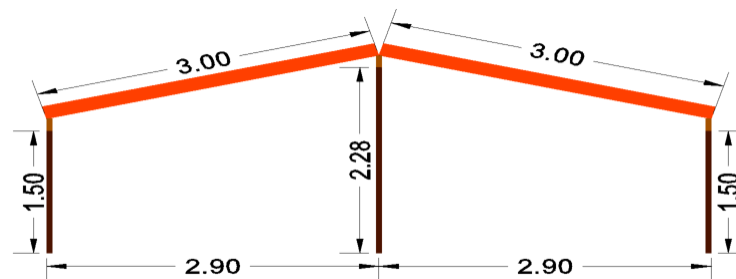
pórtico con inclinación; Fuente: (Silva & Valencia, 2023)
